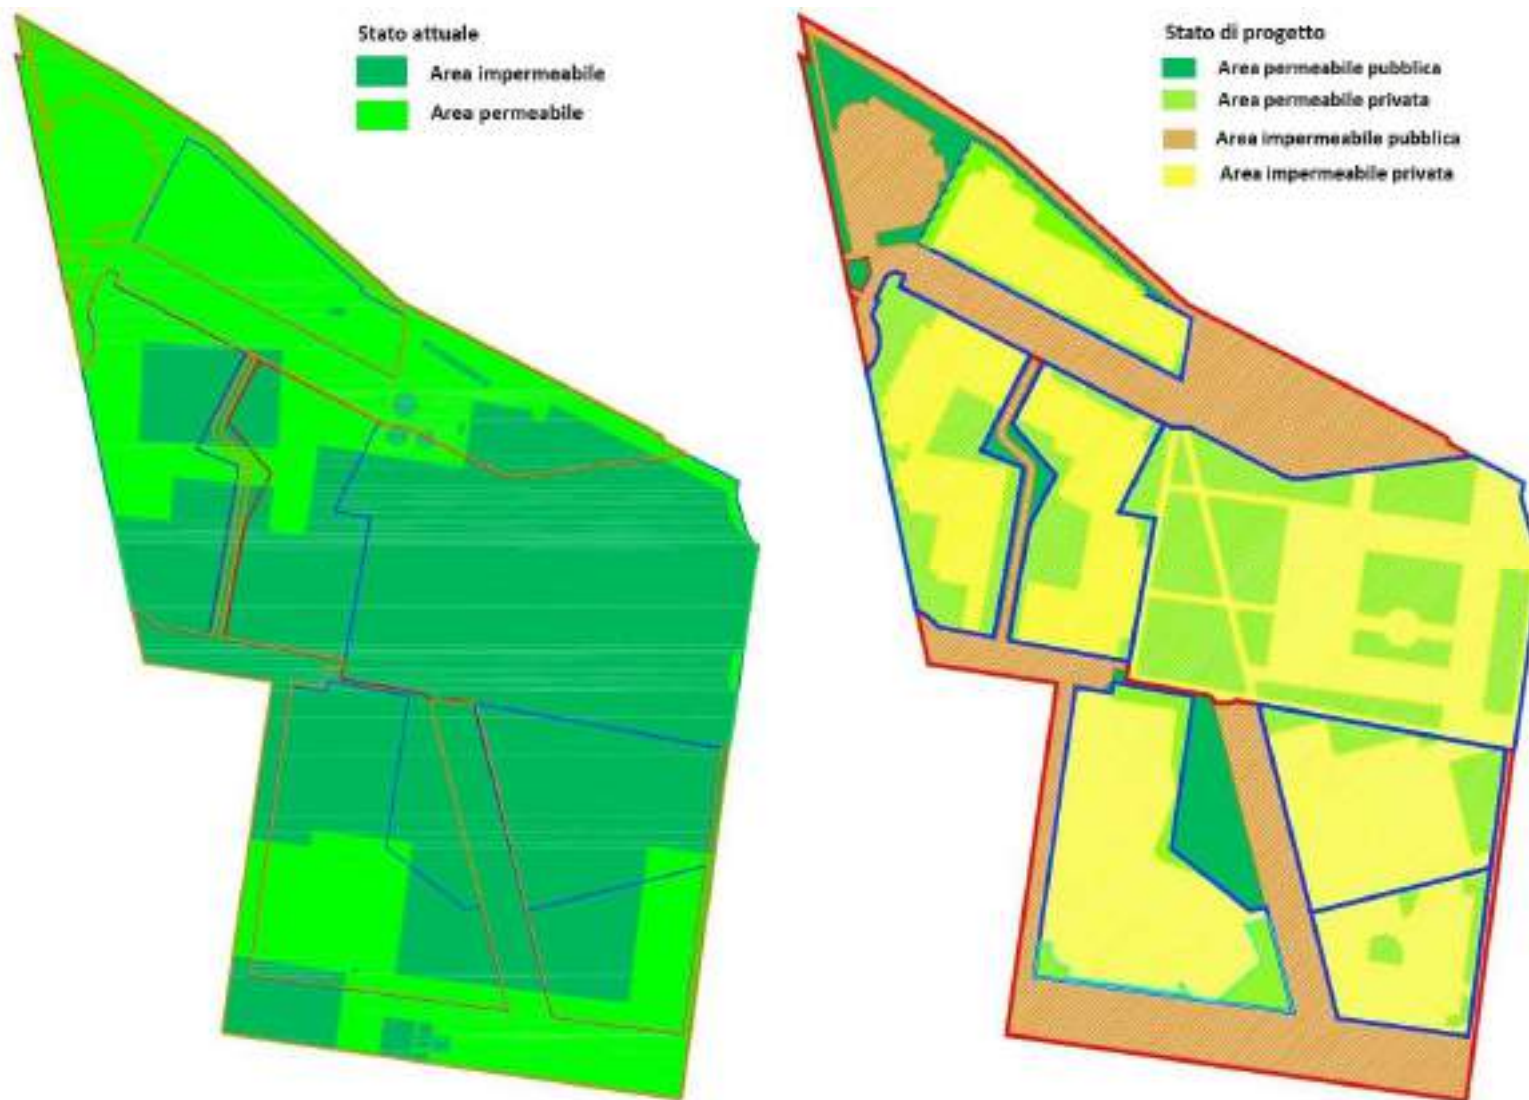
Planimetria delle aree permeabili e impermeabile (a sinistra stato attuale, a destra stato di progetto)
